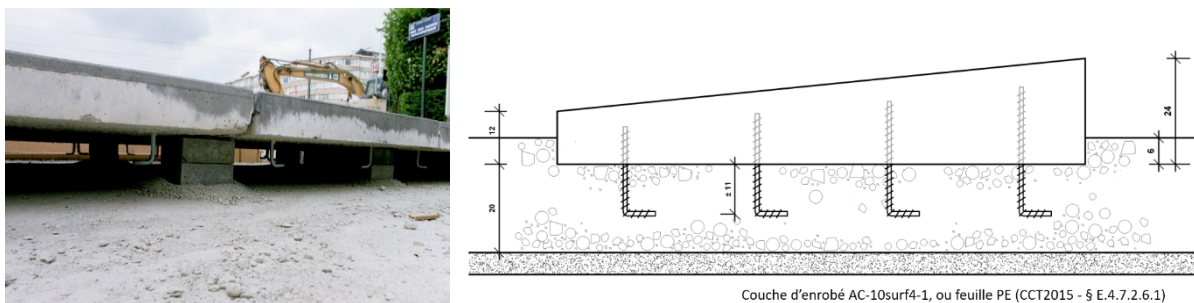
Ancrage d'éléments préfabriqués par un béton autonivelant jouant à la fois le rôle de fondation et de couche de pose
